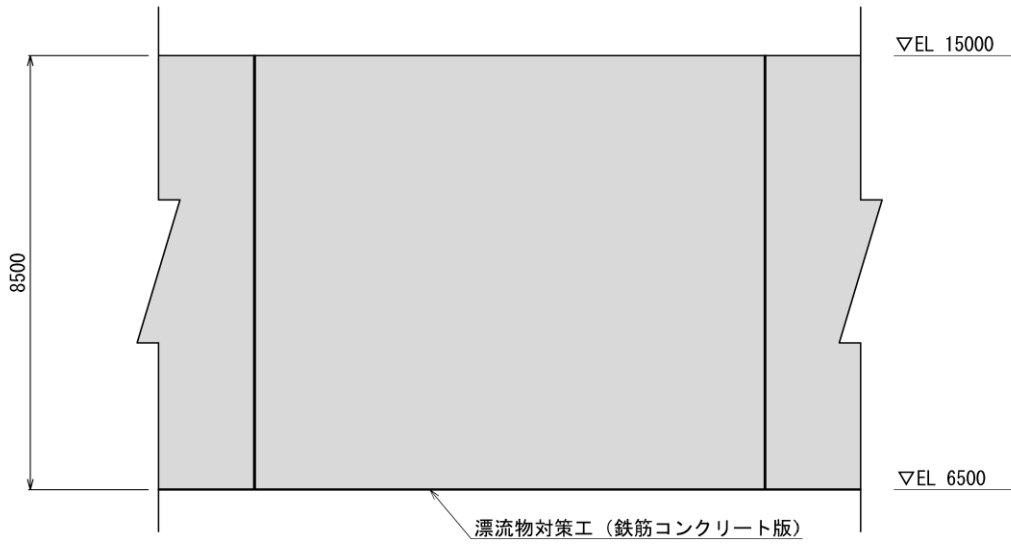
(1) 防波壁 (波返重力擁壁) 重力擁壁における漂流物対策工 (鉄筋コンクリート版) の構造概要図 (正面図)
